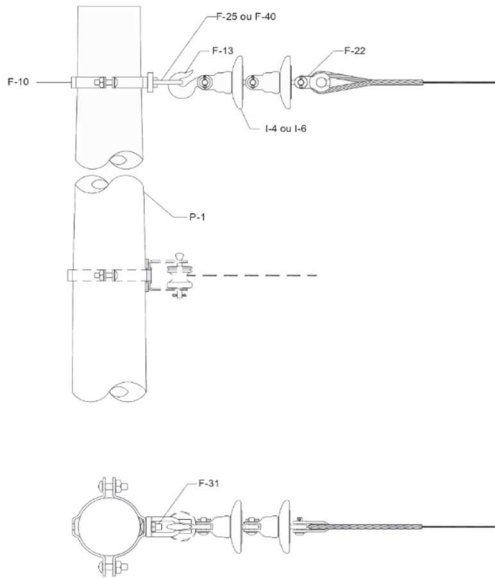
Primário – Estrutura U3 – Poste de concreto de seção circular
